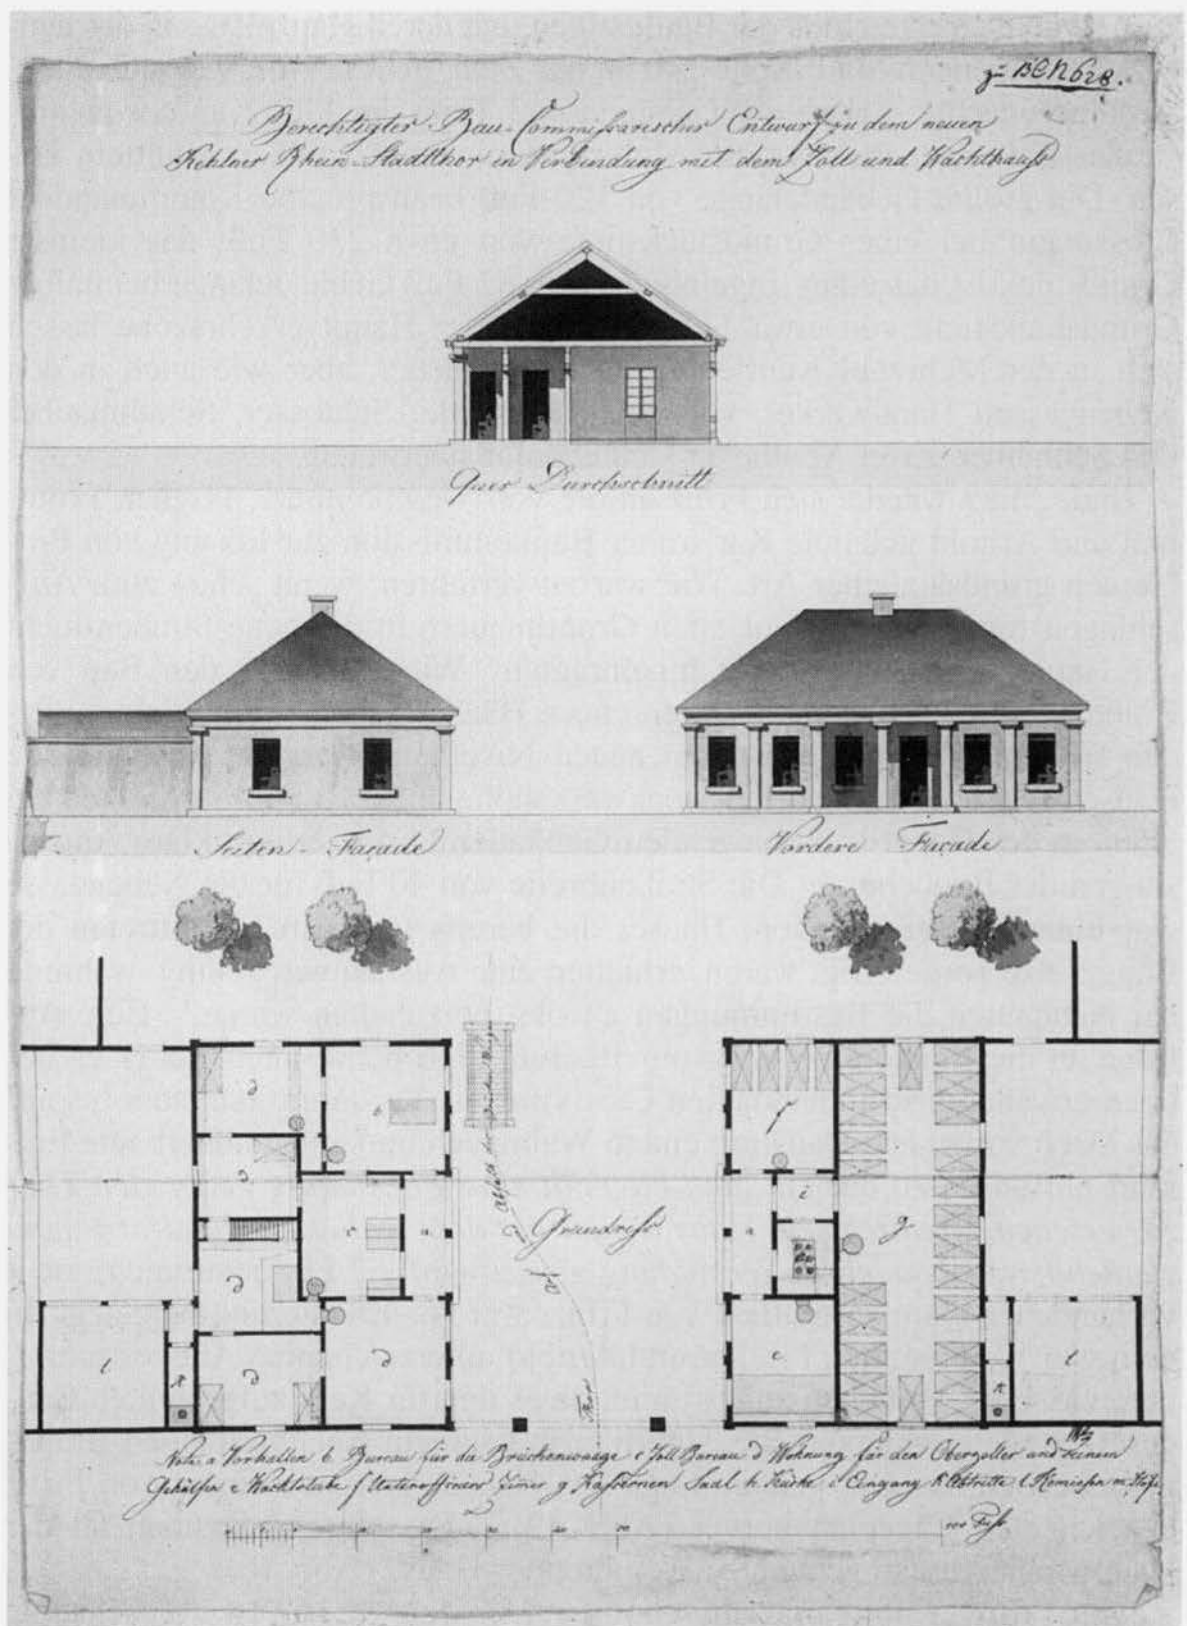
F. Weinbrenner, „Berichtigter Bau-Commissarischer Entwurf zu dem neuen Kehlner Rhein-Stadthor in Verbindung mit dem Zoll und Wachthaus“, Schnitt, Ansichten und Grundrisse, 1816, farbig aquarellierte Tuschzeichnung, M.: 100 Fuß, 10 F. = 1,9 cm, 46,4 × 34,3 cm, GLA 422/866
